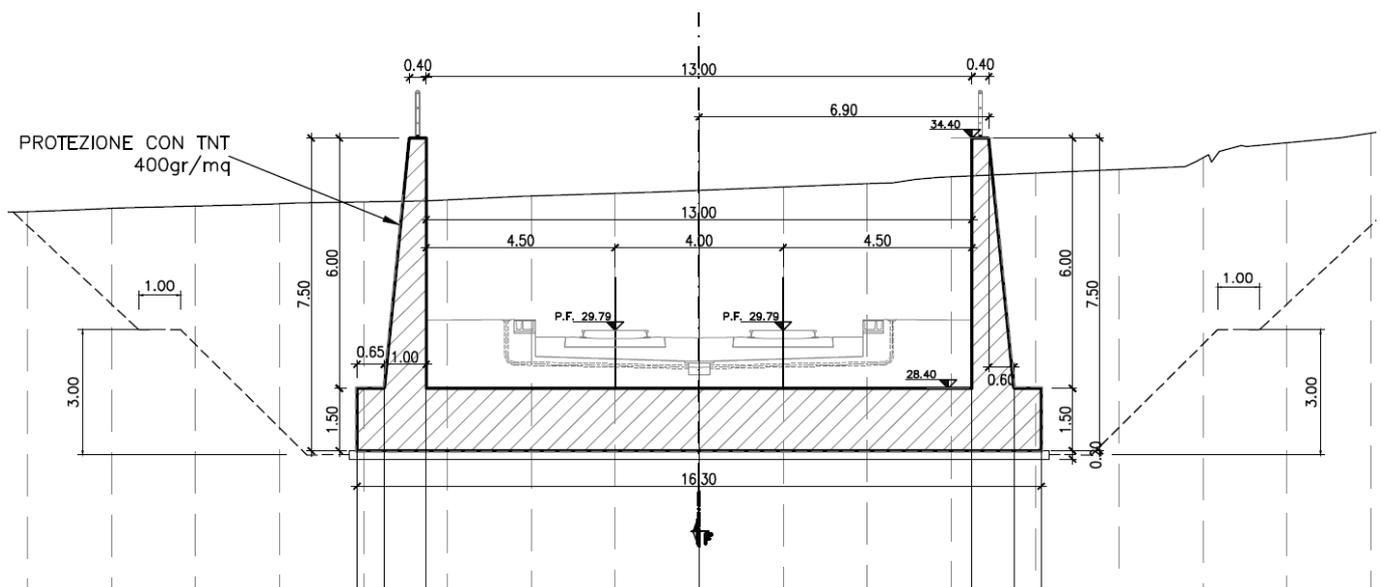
Sezione muro di imbocco (Hmin=6.00 m)
